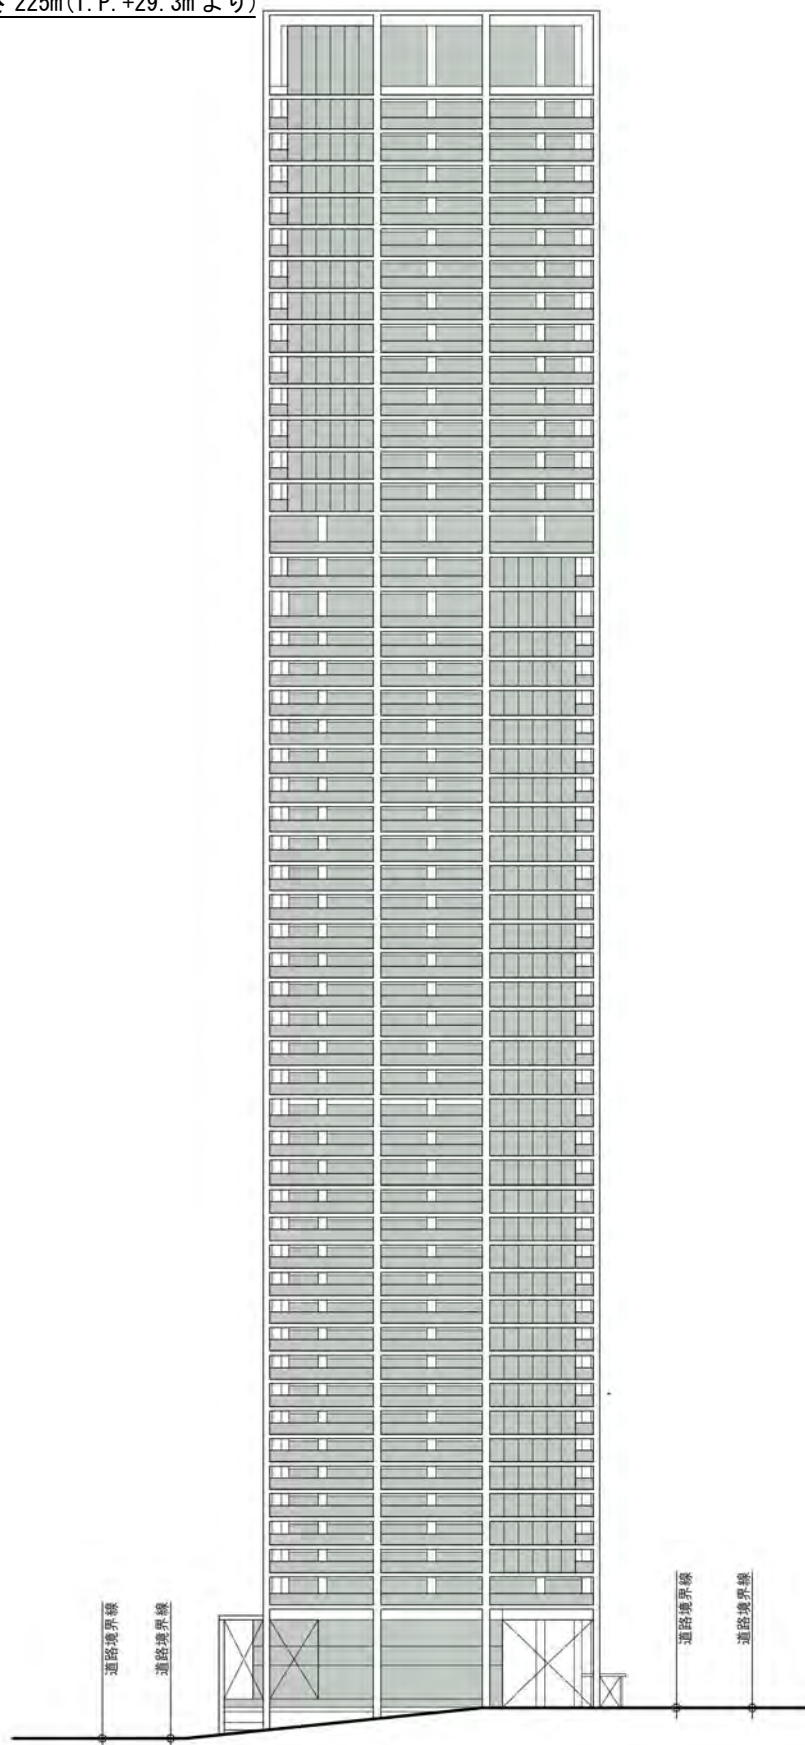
(1) 立面図（北立面図 S=1:1,000）【変更前】
